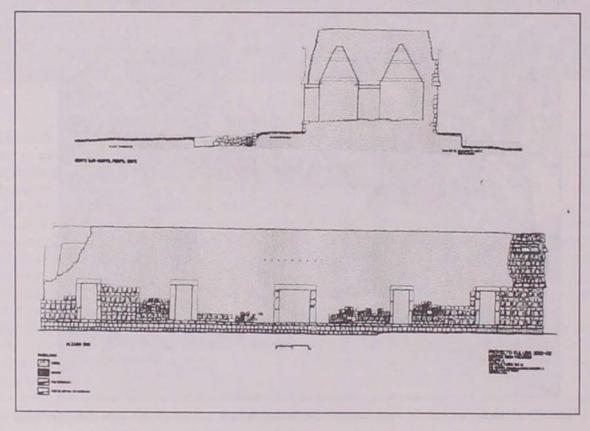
Corte norte sur y fachada sur de la Estructura 11k1a.
